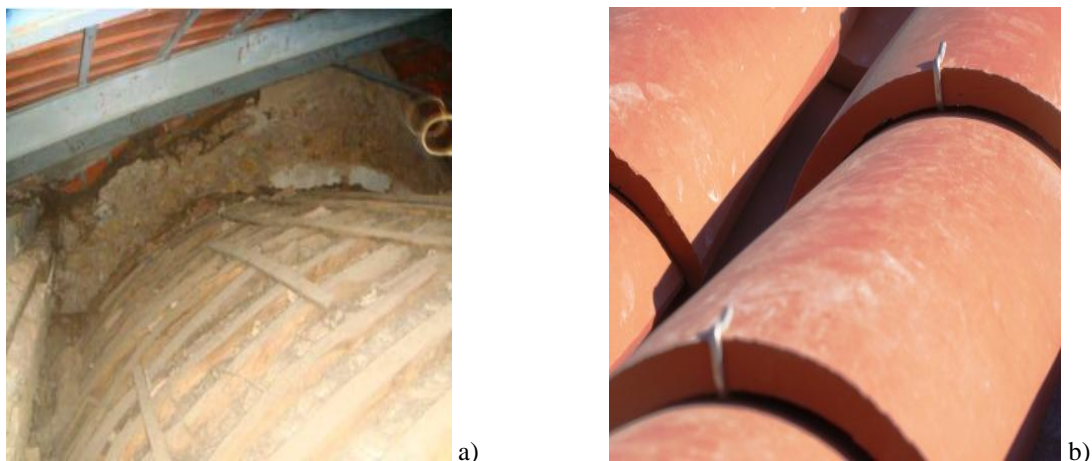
a) Extradorso da abóbora e estrutura metálica do telhado; b) Telhas grampeadas.
